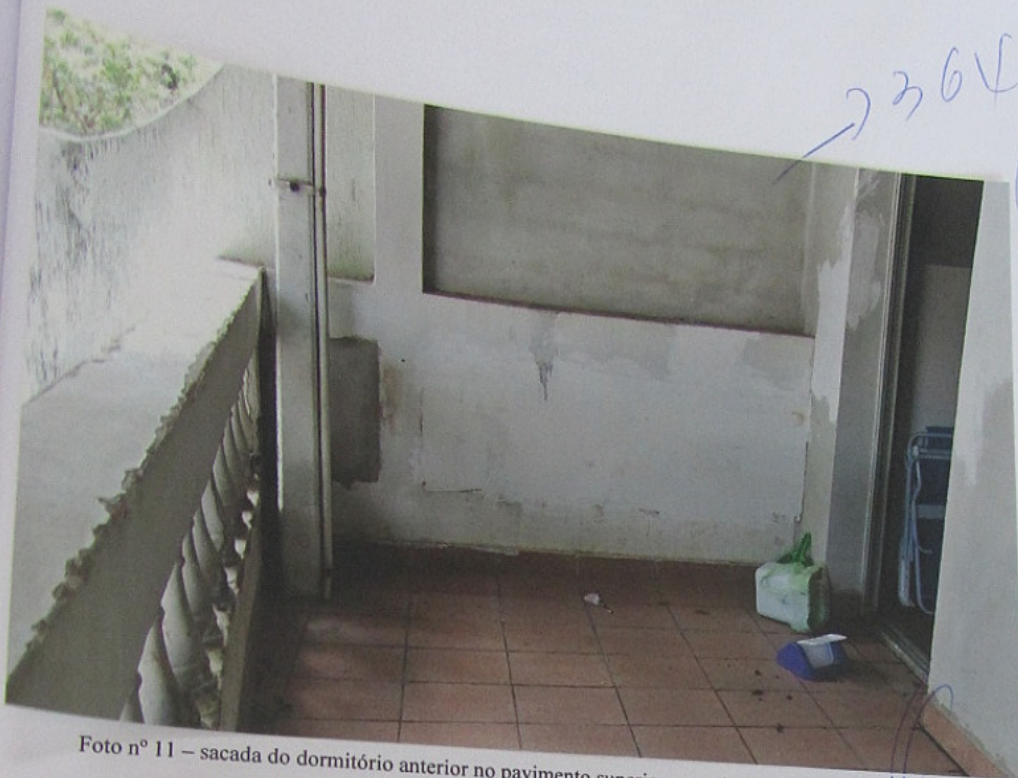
sacada do dormitório anterior no pavimento superior com piso cerâmico
